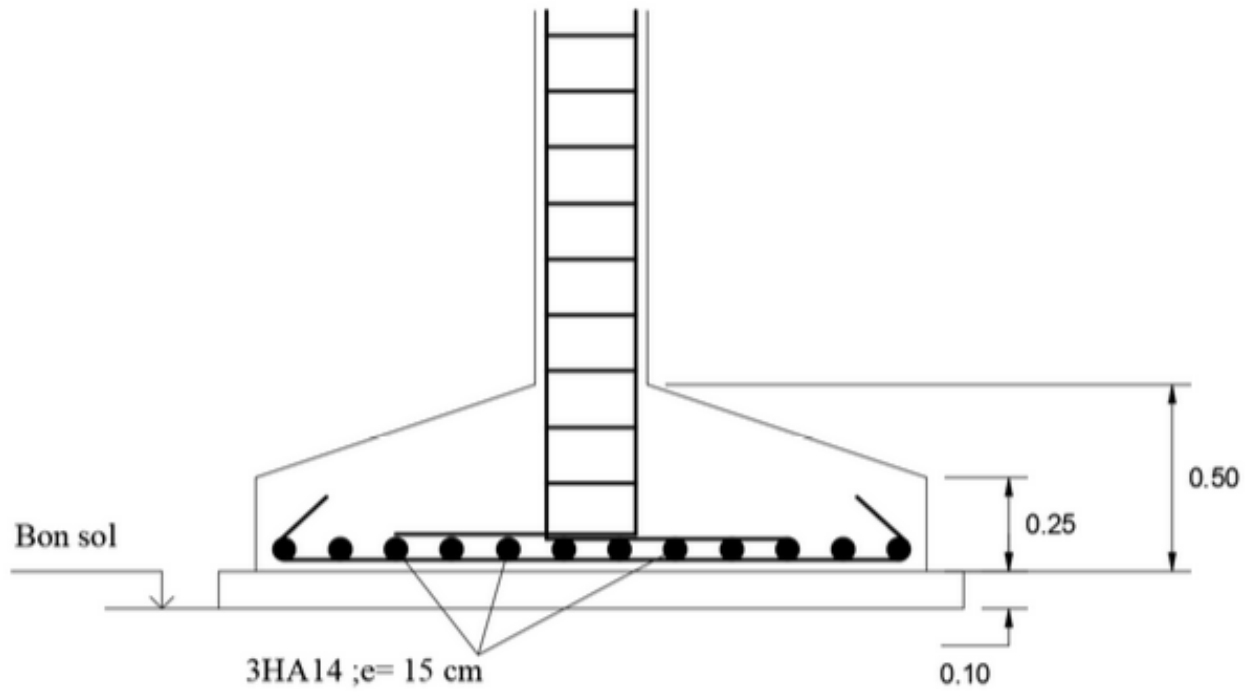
Schéma de ferrailage de la semelle isolée S1
